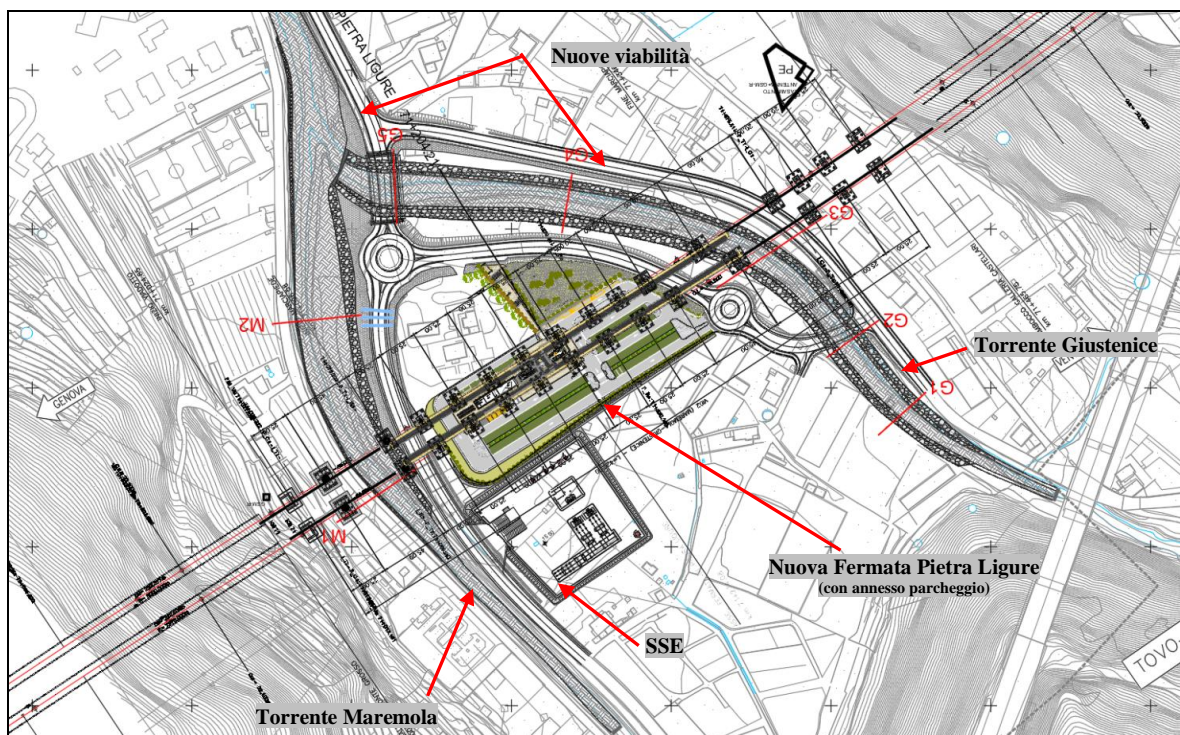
Stralcio della planimetria di progetto in quel di Pietra Ligure
